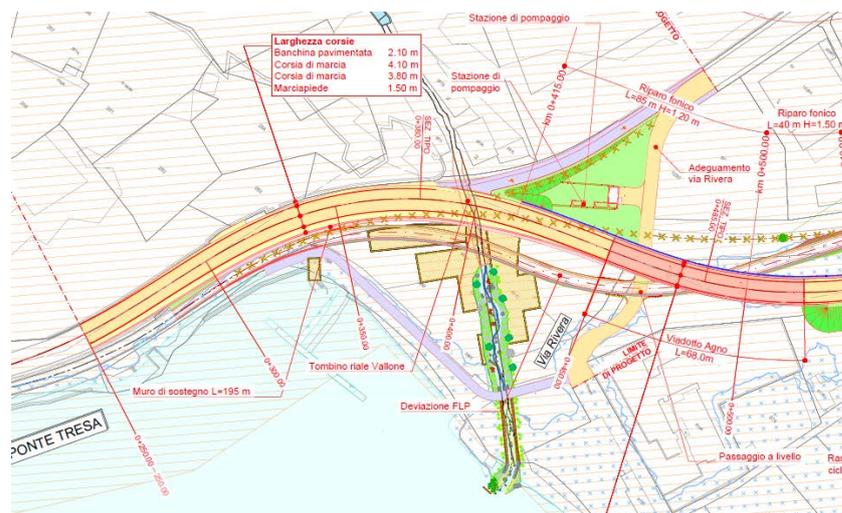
Estratto planimetrico raccordo Contrada San Marco
